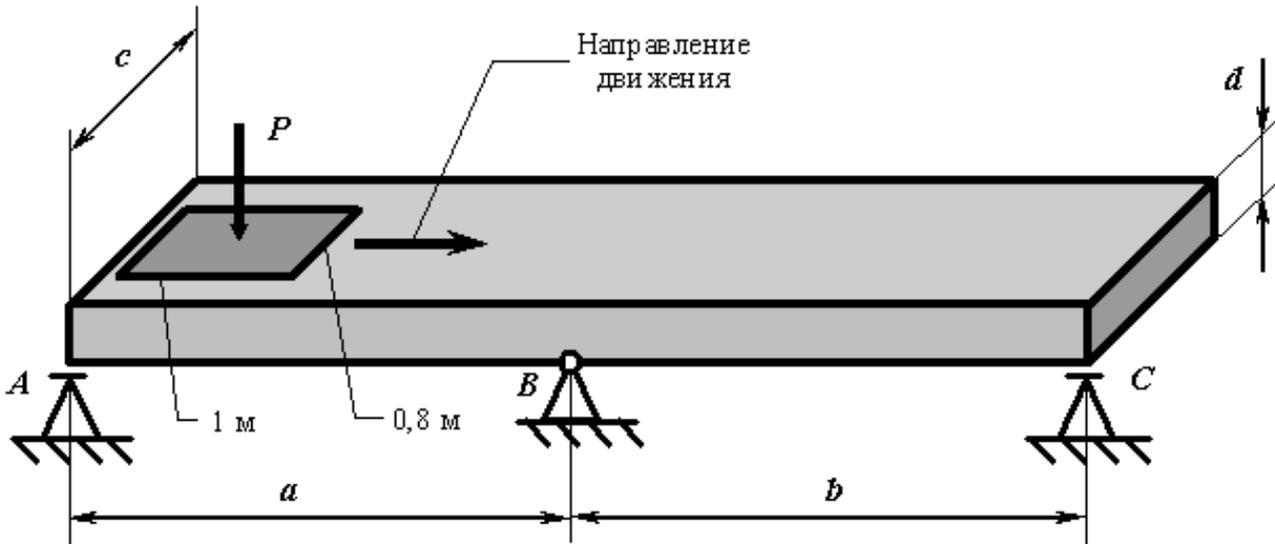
Расчетная схема железобетонной конструкции
